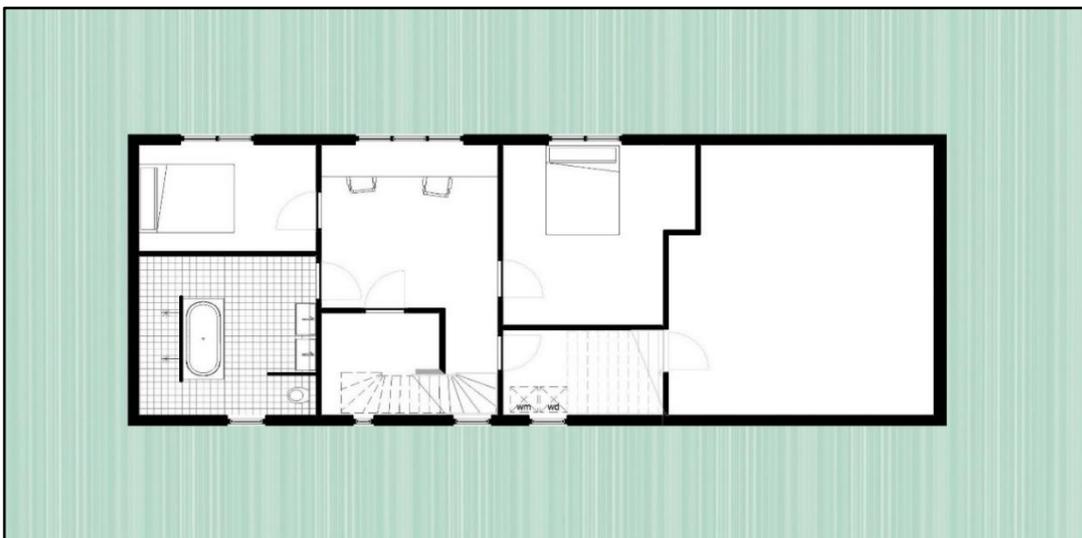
Vista en Planta de Vivienda Tipo 2º piso
